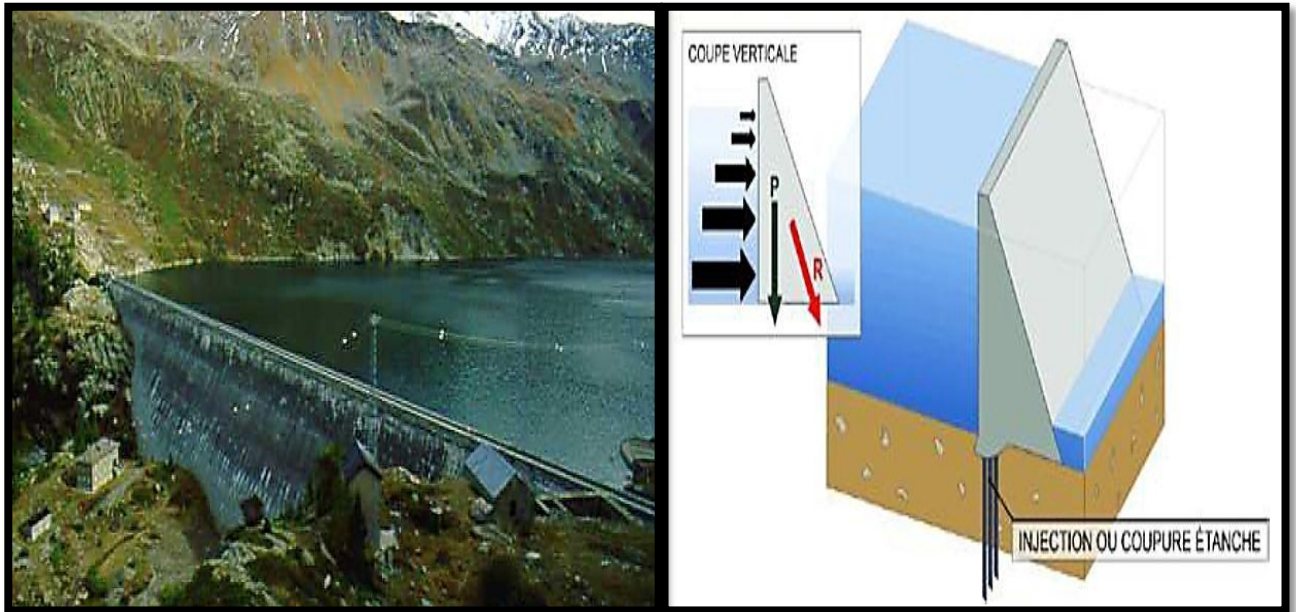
Schéma d'un barrage en béton -type poids[6].
